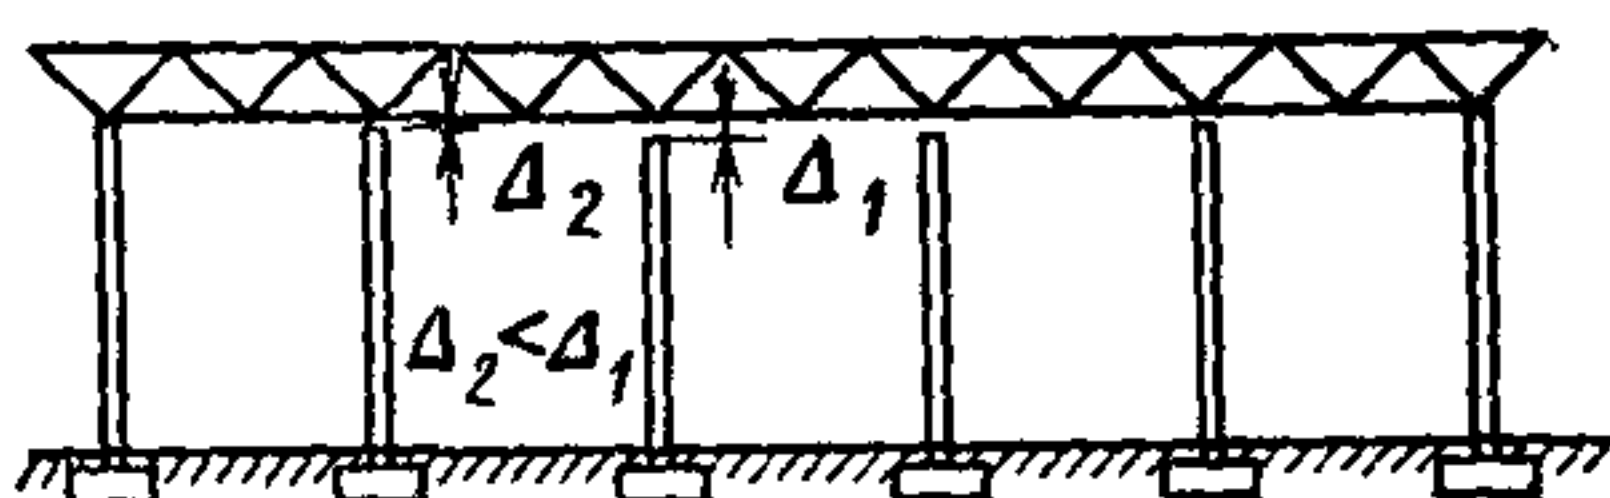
Выравнивание усилий в поясных сетках путем осадки опор
